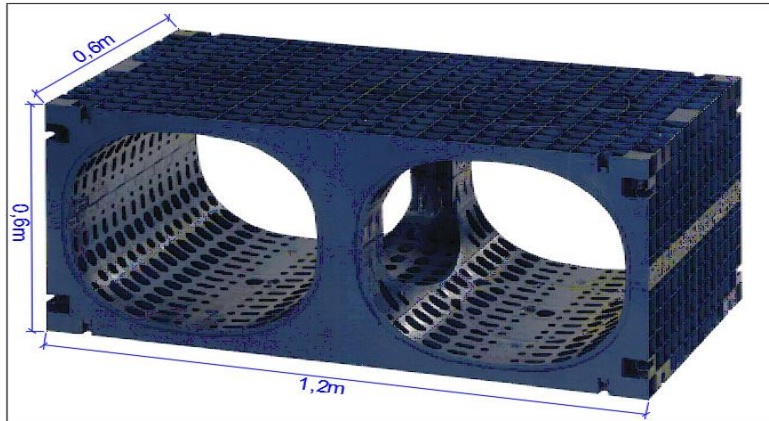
Detaljtegning fordrøyningsanlegg (rør) ( kilde: Alan Permiss)
